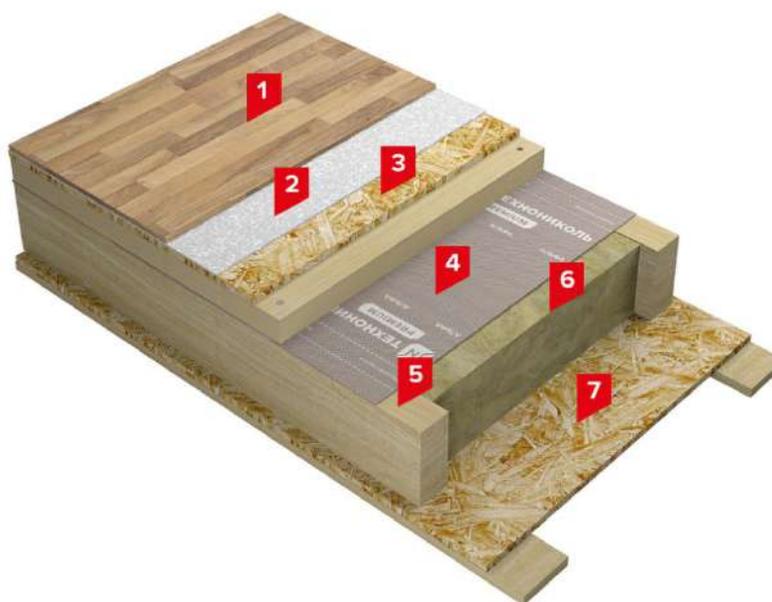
«Пирог» межэтажного деревянного перекрытия
